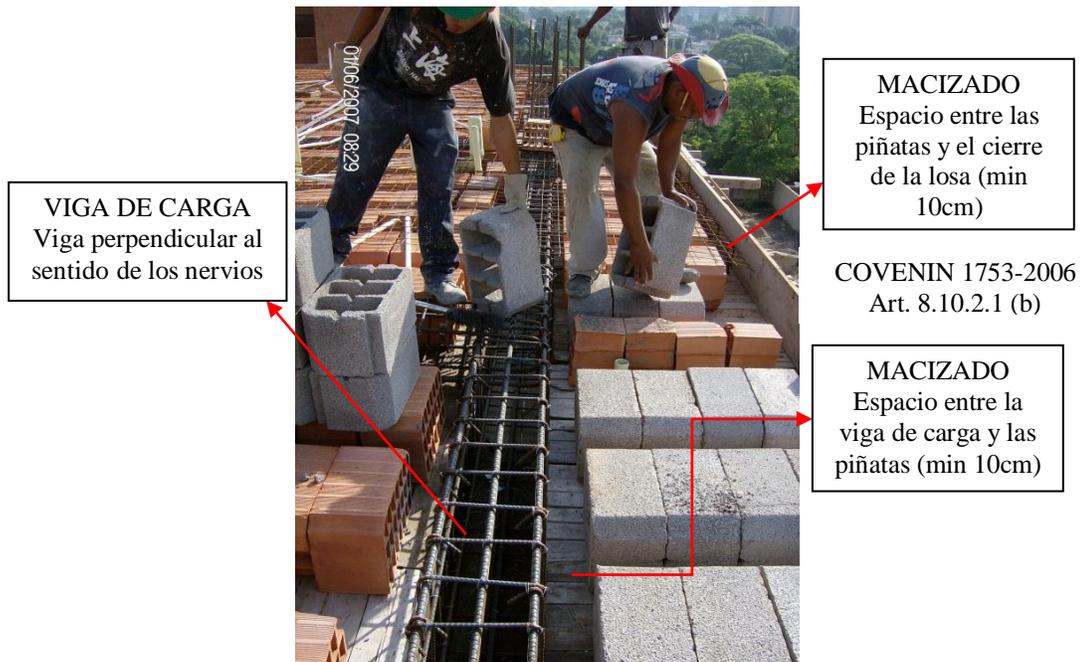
Colocación de piñatas en planta de envigado de entrepiso. Losa nervada en una dirección. (Edificio de apartamentos). *Nota.* Bonucci (2012).
